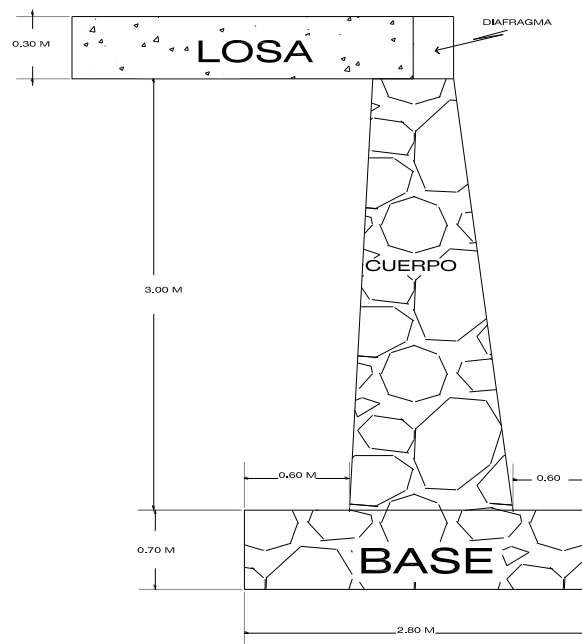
Muro de contención para alcantarilla tipo A.
